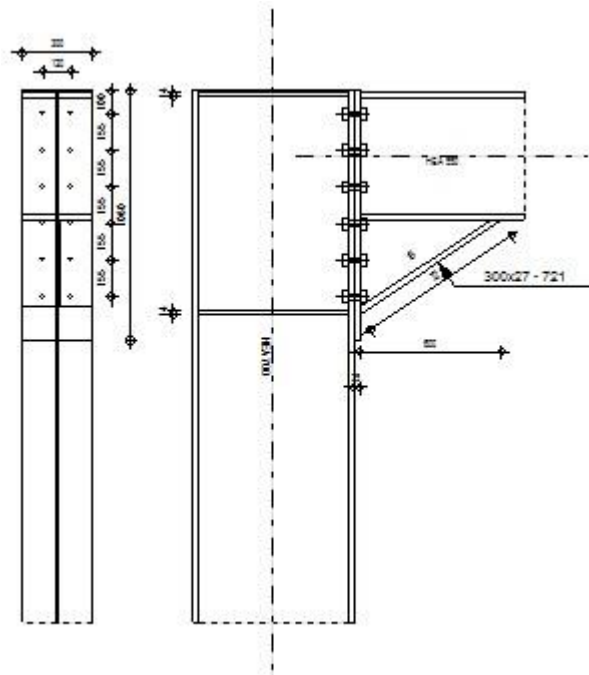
Vérification de l'assemblage poteau-poutre
